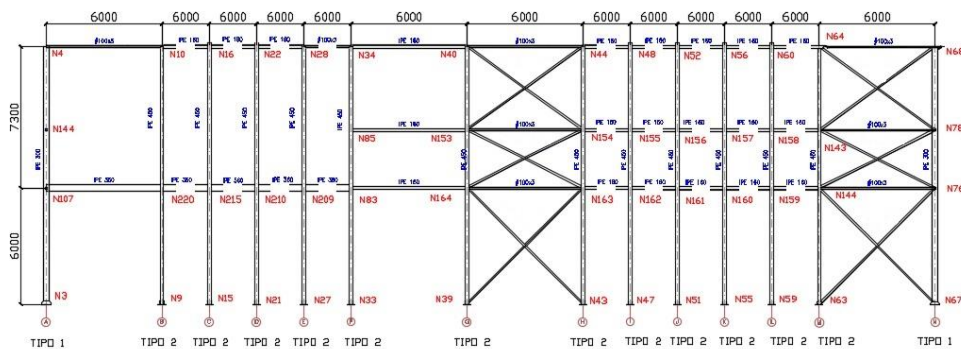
Fachada lateral intermedia. (Fuente: Creación propia)
